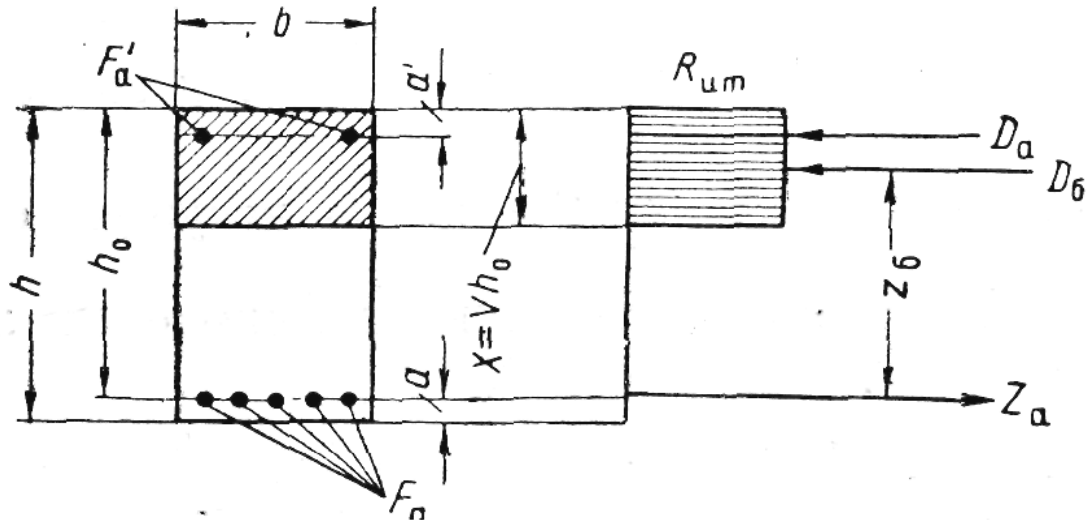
Прямокутний переріз з подвійною арматурою при згині
